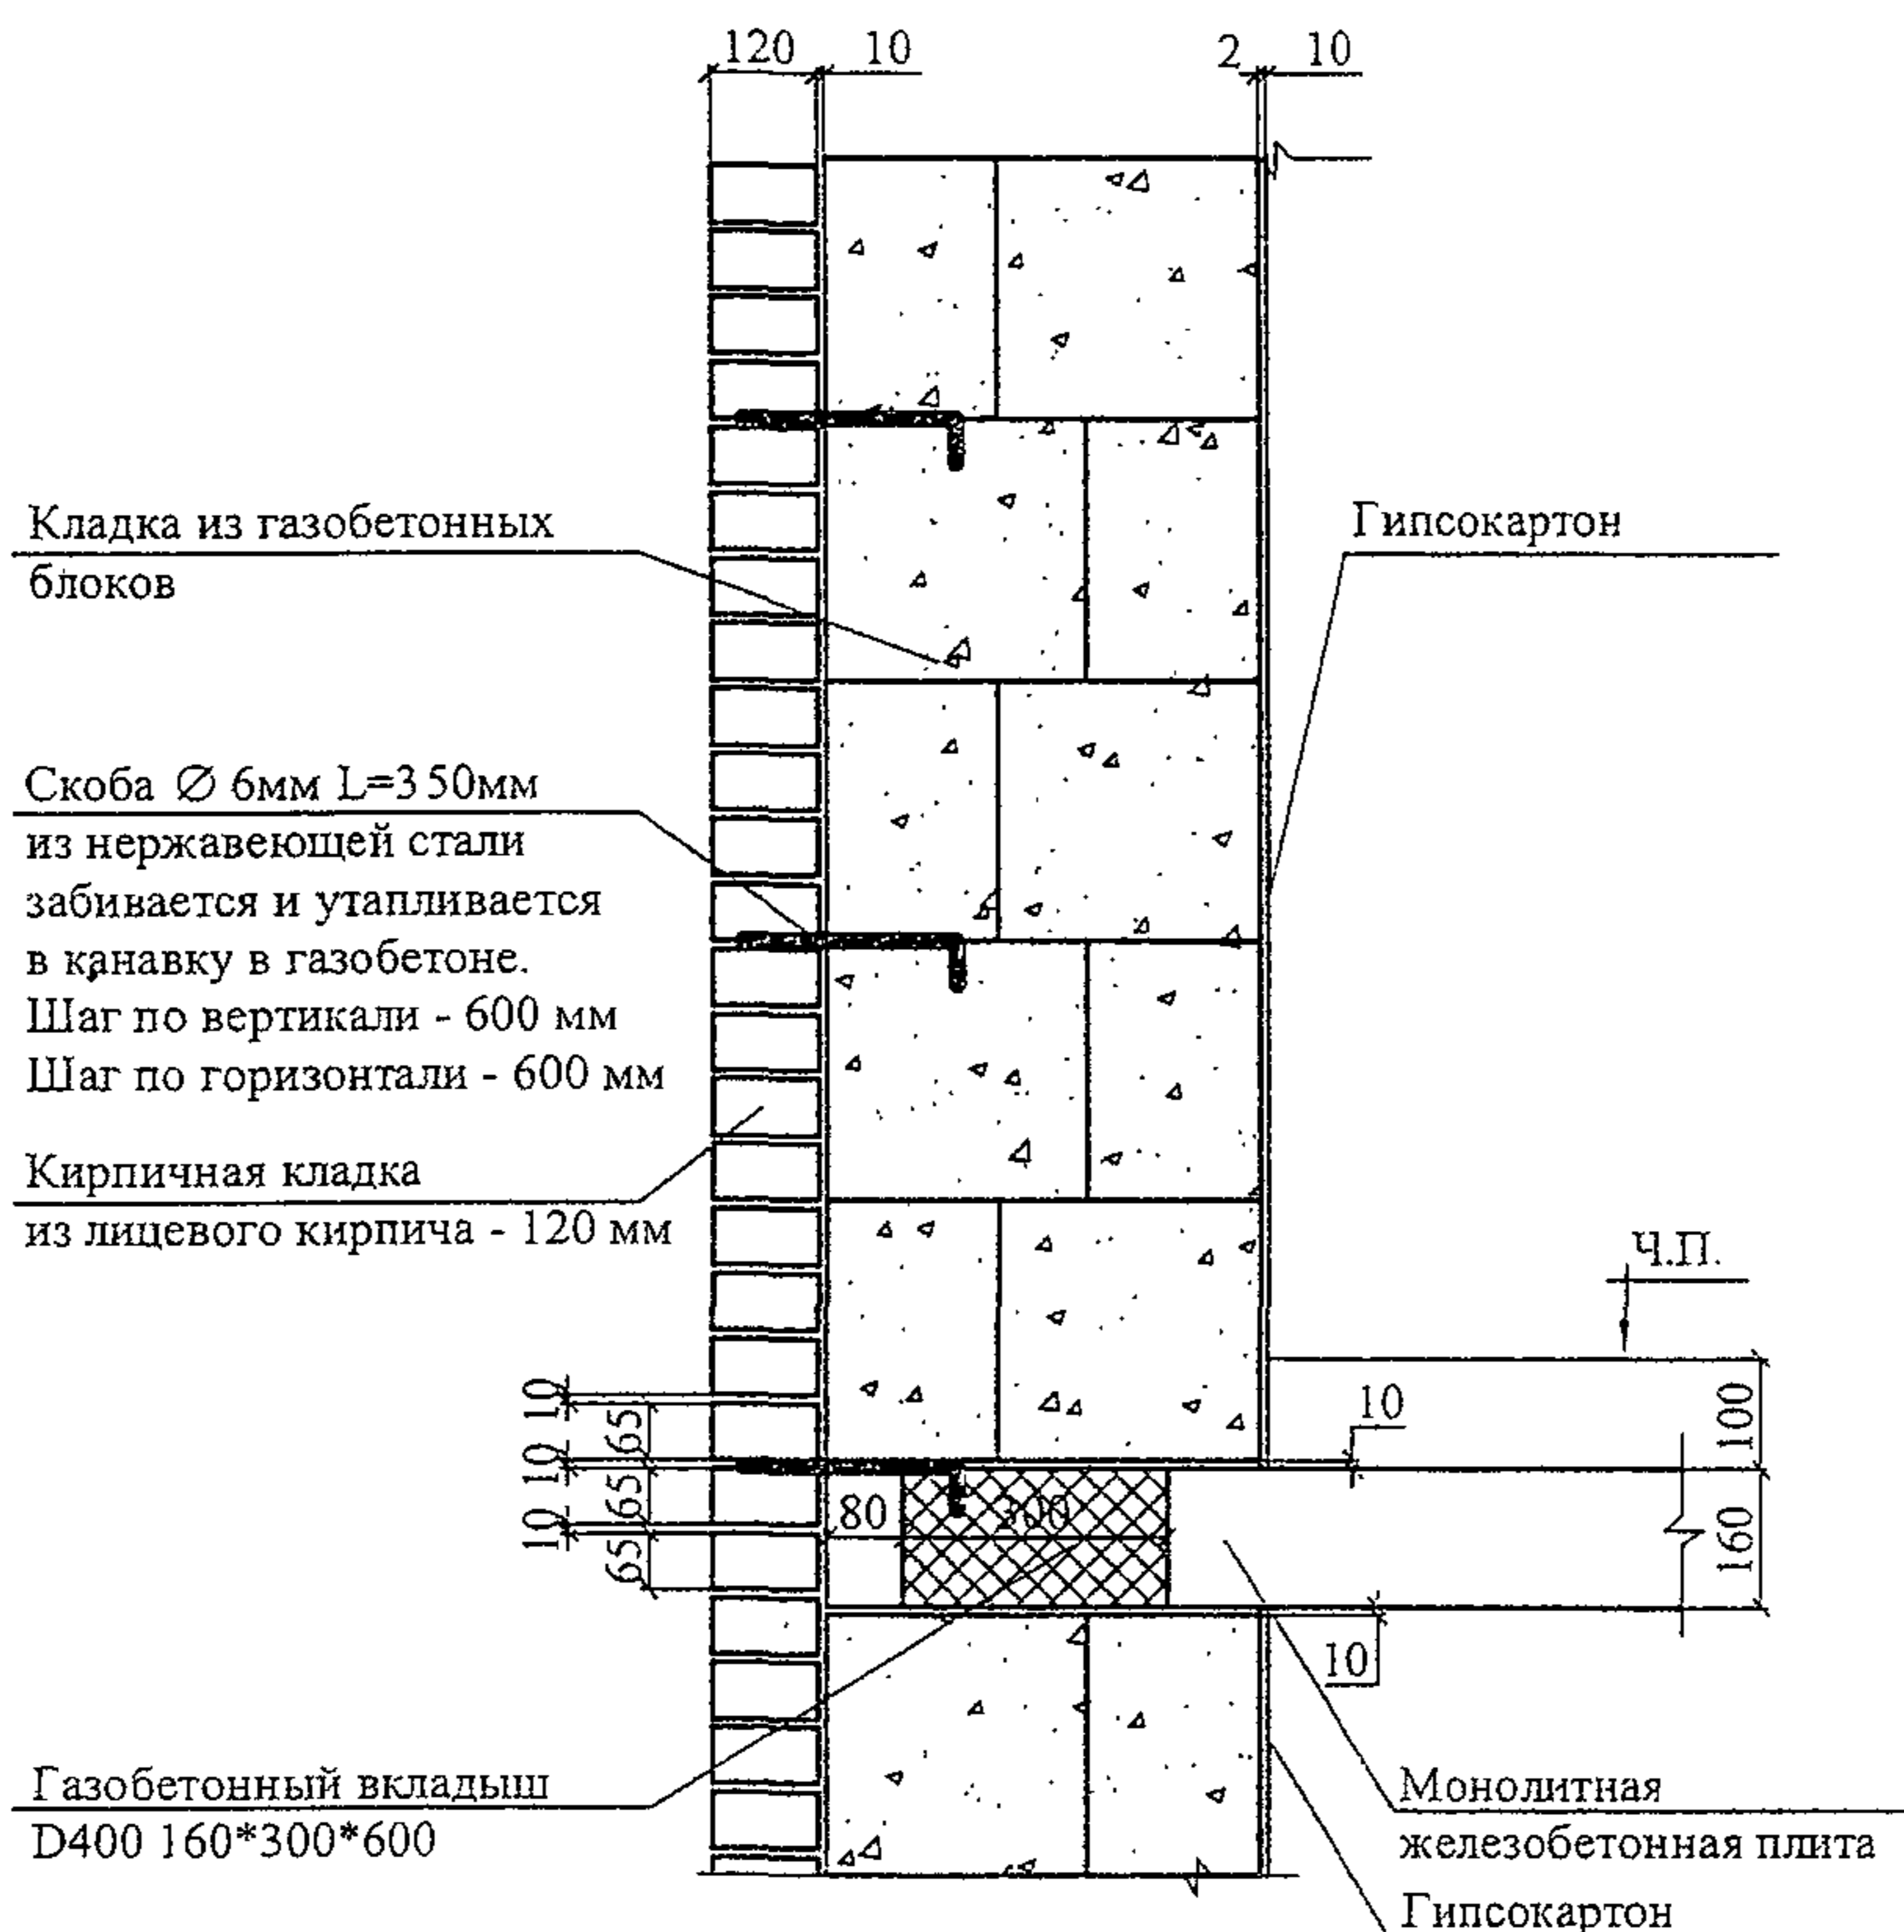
Несущая стена малоэтажных домов из газобетонных блоков на клею и самонесущей кирпичной облицовки
